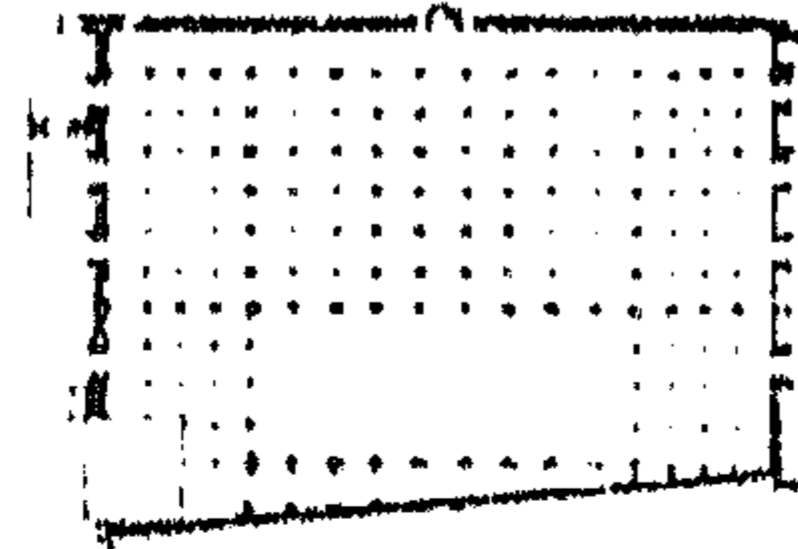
٧٨ : المسقط الأفقي لمسجد وضريح السلطان قايتباي
